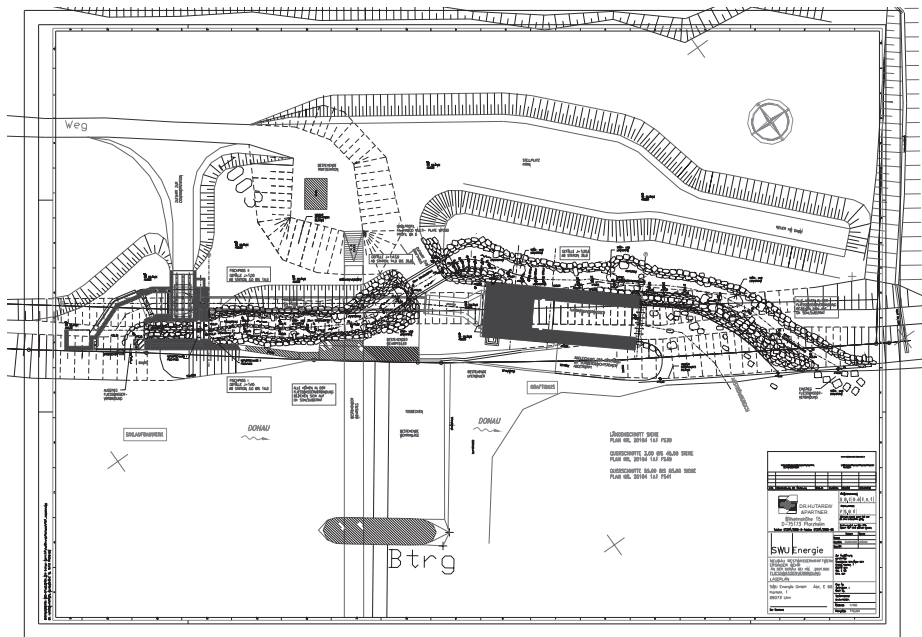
Lageplan Mindestwasserkraftwerk mit Umgehungsgewässer.
